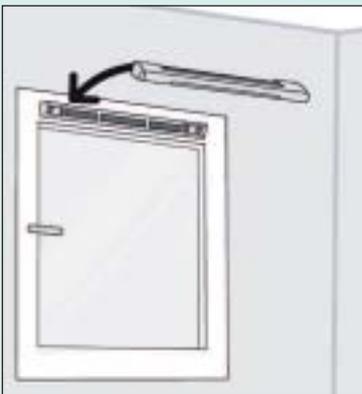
exemple de fixation d'une entrée d'air sur fenêtre
